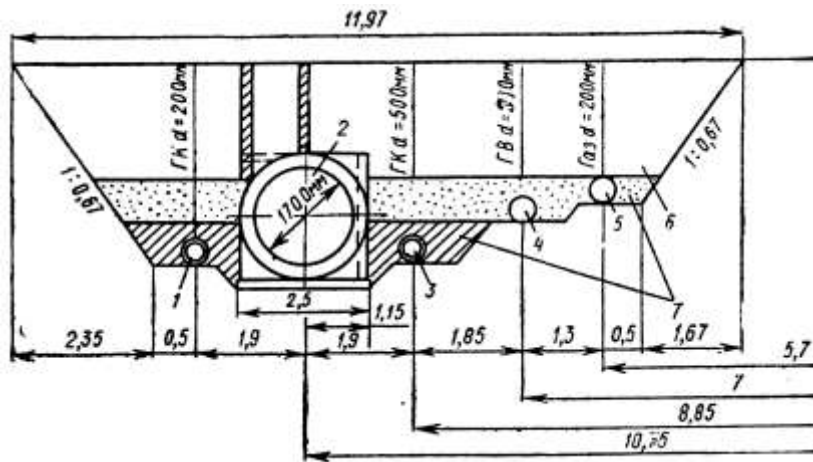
Сумісне прокладання підземних трубопроводів
